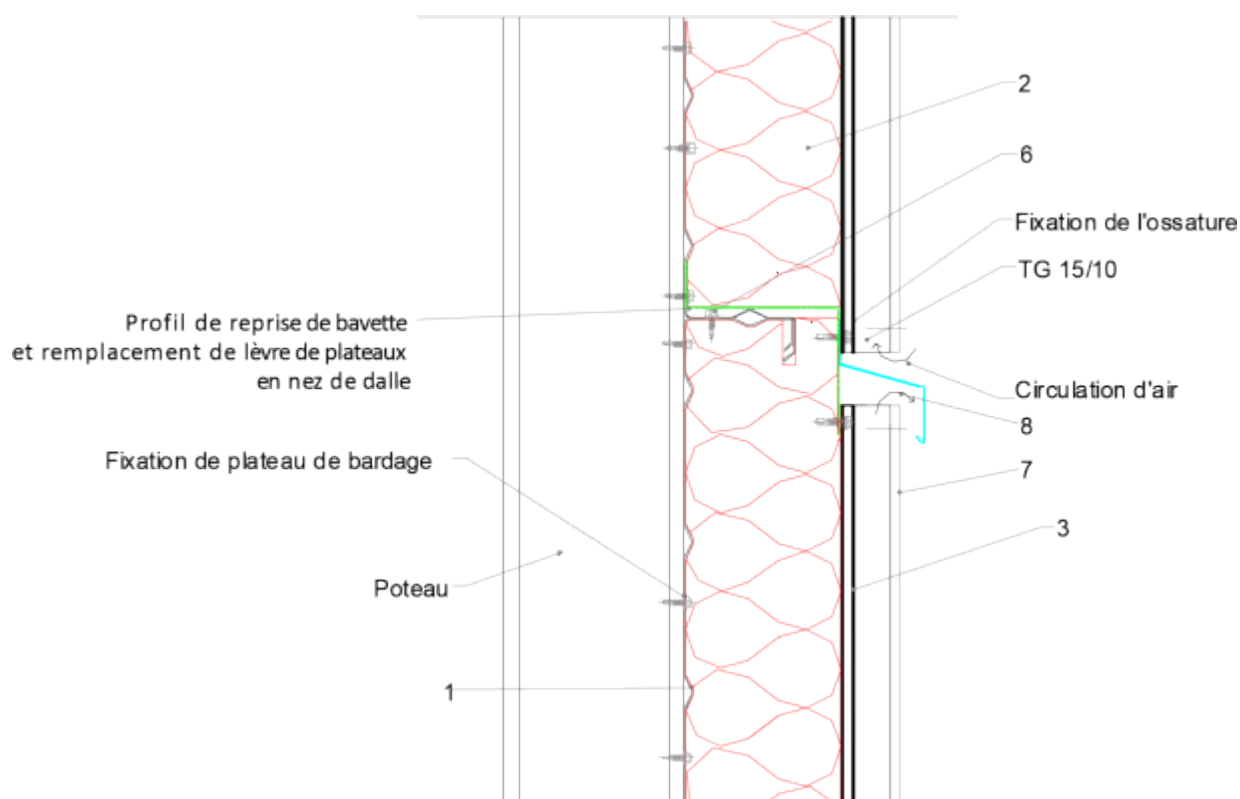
Fractionnement de lame d'air – Coupe verticale
